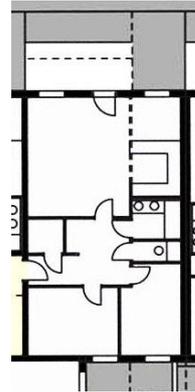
3-Zimmer Wohnung mit flexibel nutzbarer Küchenzone im Wohn/Essraum, Bauteil Arch. Peretti
